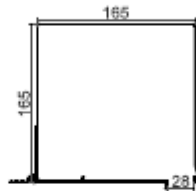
Querschnitt Rolladenkasten (SP-E 165)
